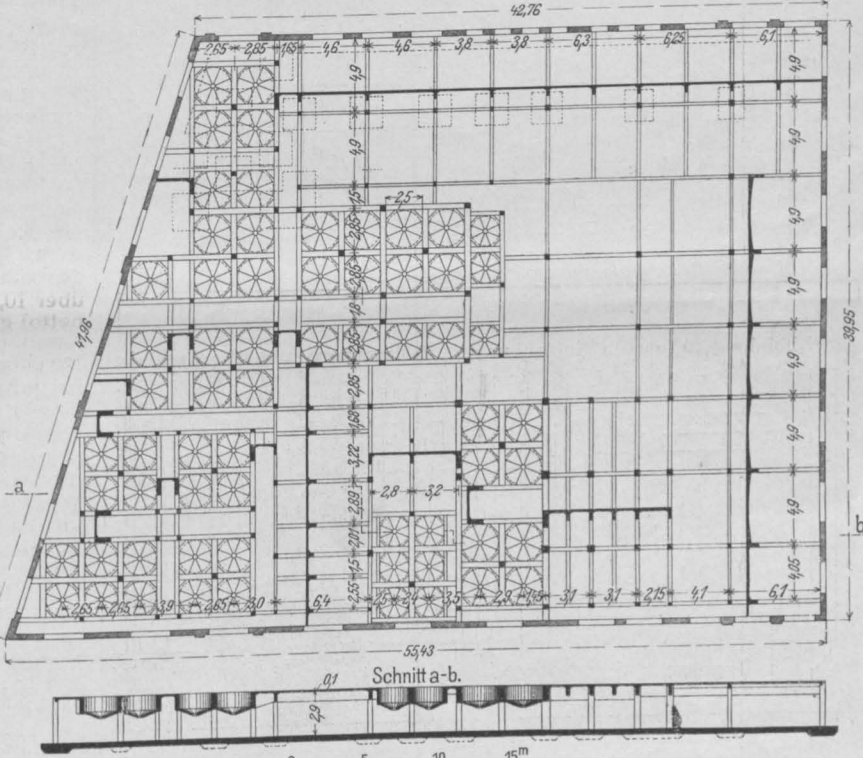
Grundriß und Schnitt der Raffinerie mit 64 Oeltanks.
